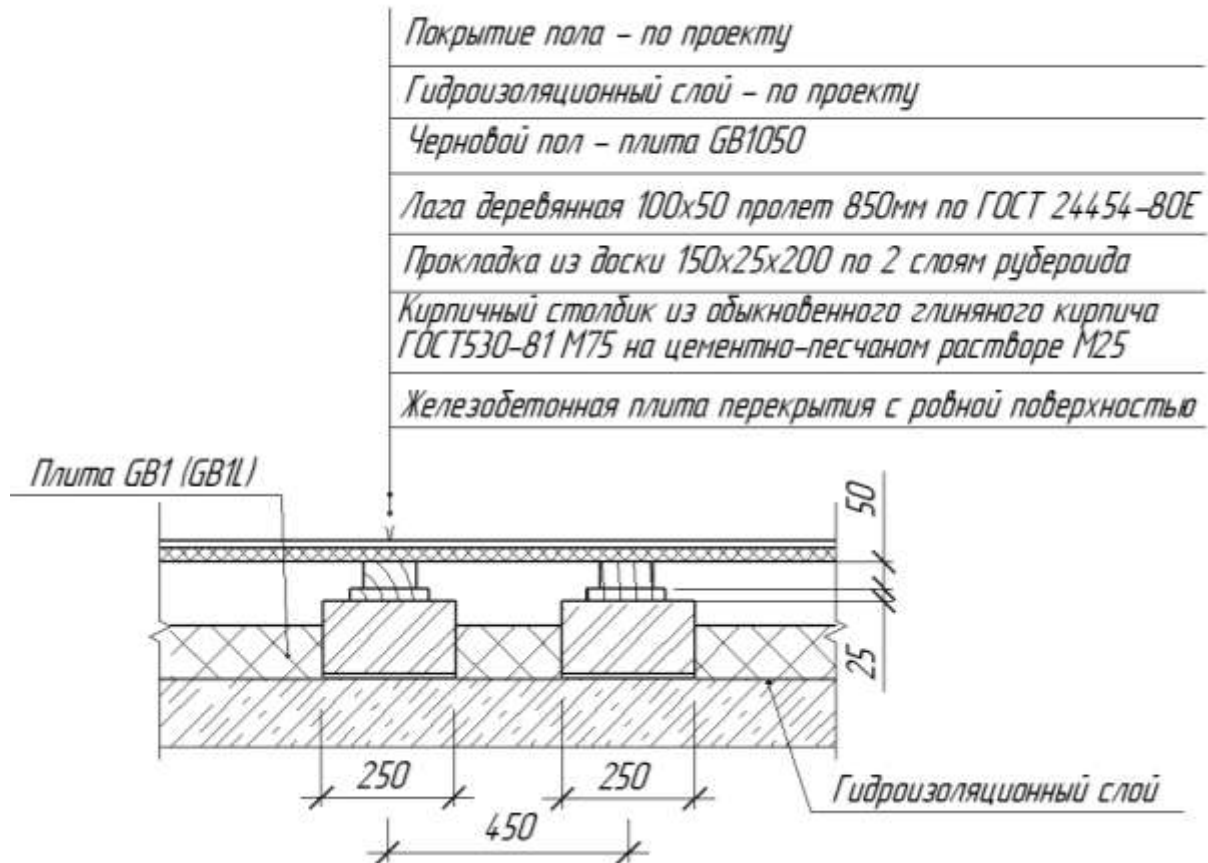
Конструкция пола по железобетонной плите перекрытия на кирпичных столбиках с утеплением с применением системы плит GREEN BOARD®
